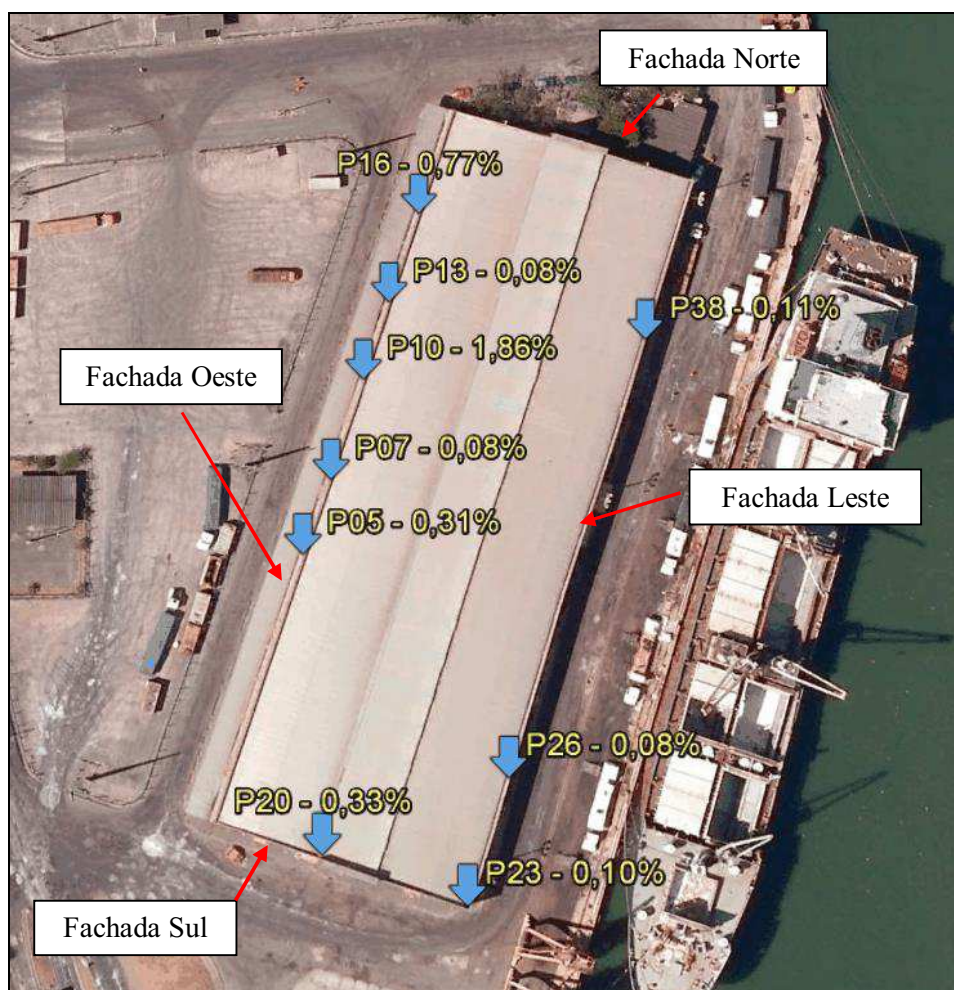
Posicionamento dos pilares e resultados da segunda fase do ensaio de teor de cloreto em relação à massa de cimento.
